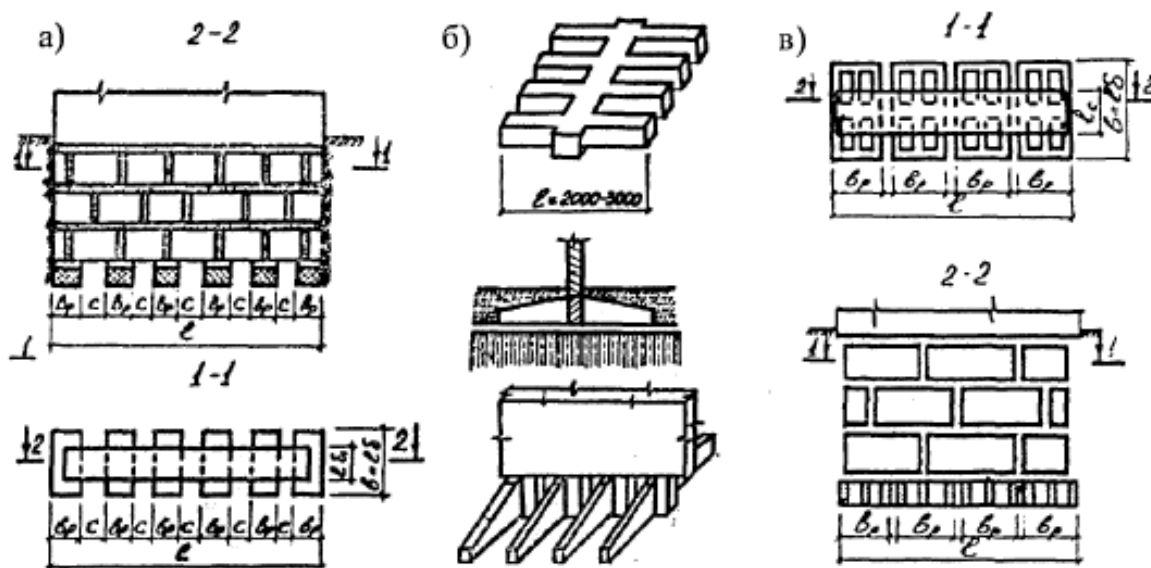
Деякі види переривчастих фундаментів: а-стрічковий переривчастий фундамент; б- переривчасто-шпальний фундамент; в - переривчасто-ґратчастий фундамент [1-3]
